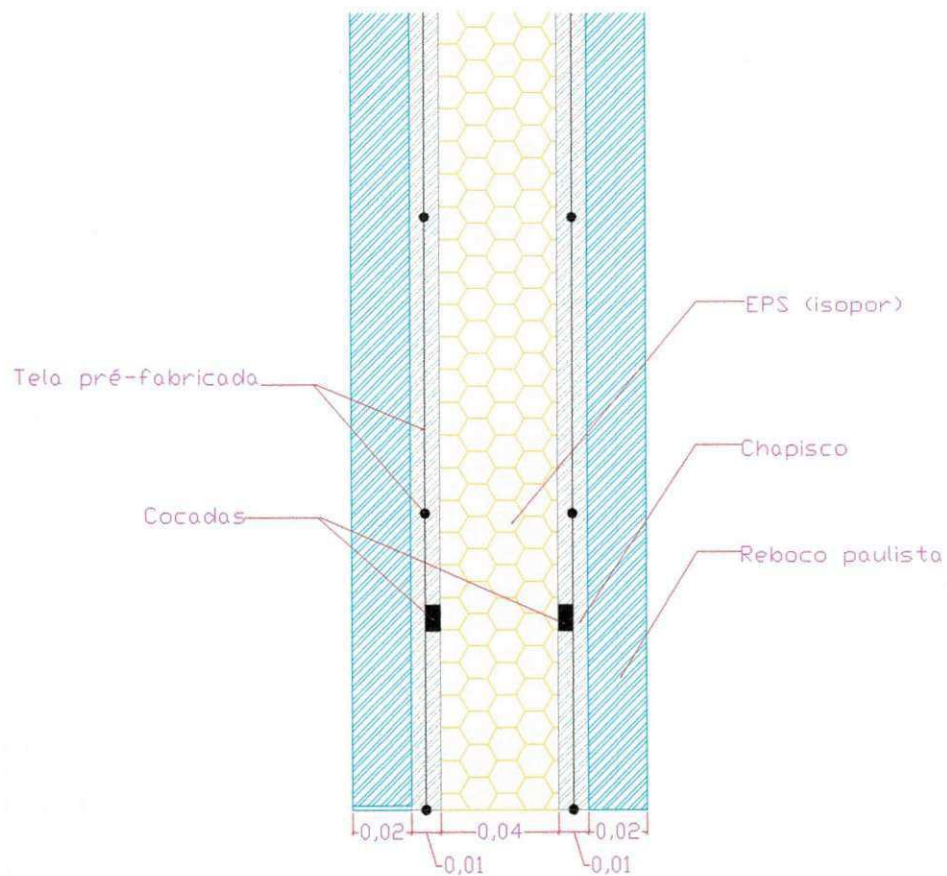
Detalhe da Alvenaria Alternativa empregando “EPS + Argamassa Armada”
